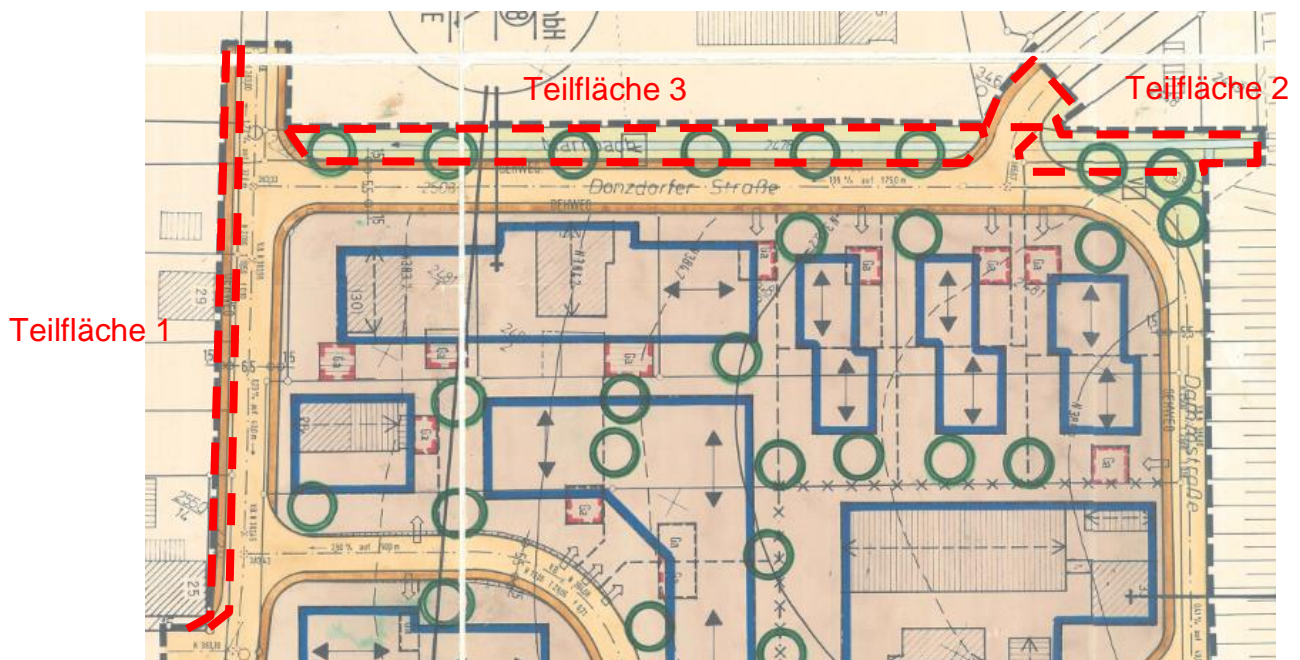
Schematische Darstellung der Aufhebungsbereich auf Grundlage des zeichnerischen Teils des bestehenden Bebauungsplans „Marrbachöschle“
